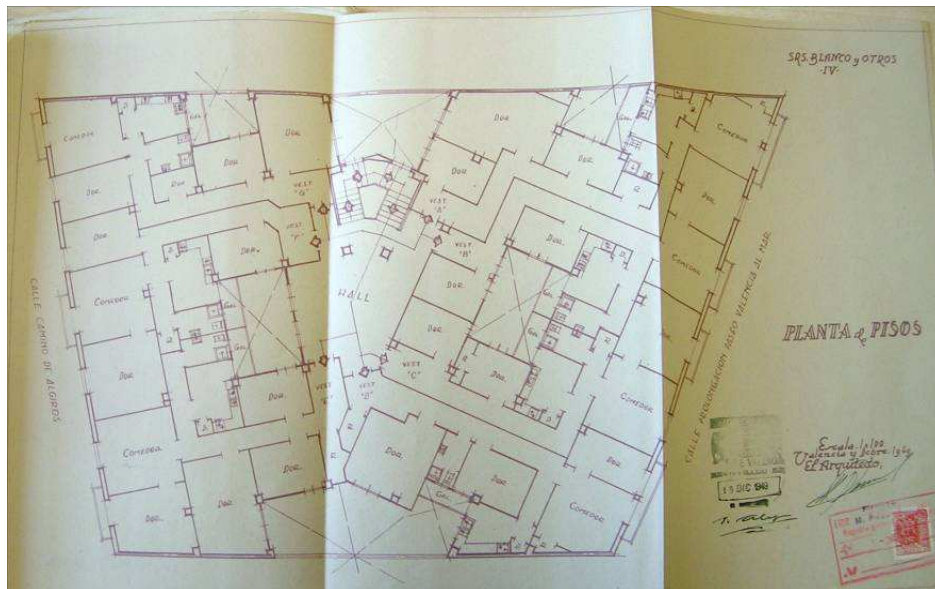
Planta de distribución. Edificio ficha 75C.007
